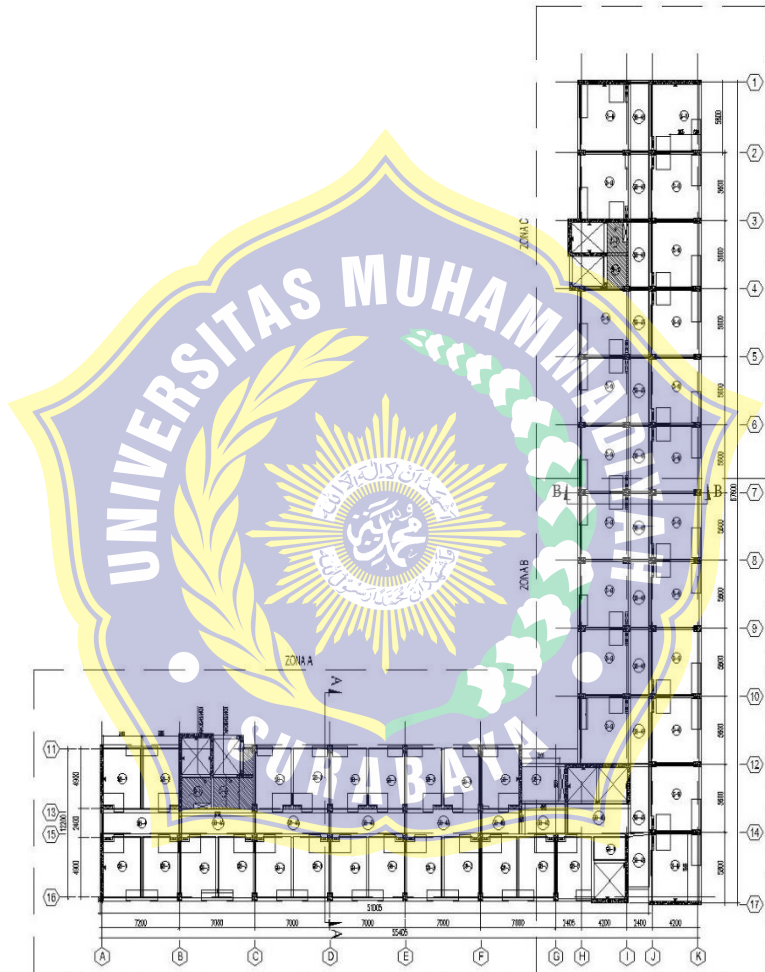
Denah Pelat HCS lantai 2 – 10 (Typical)
